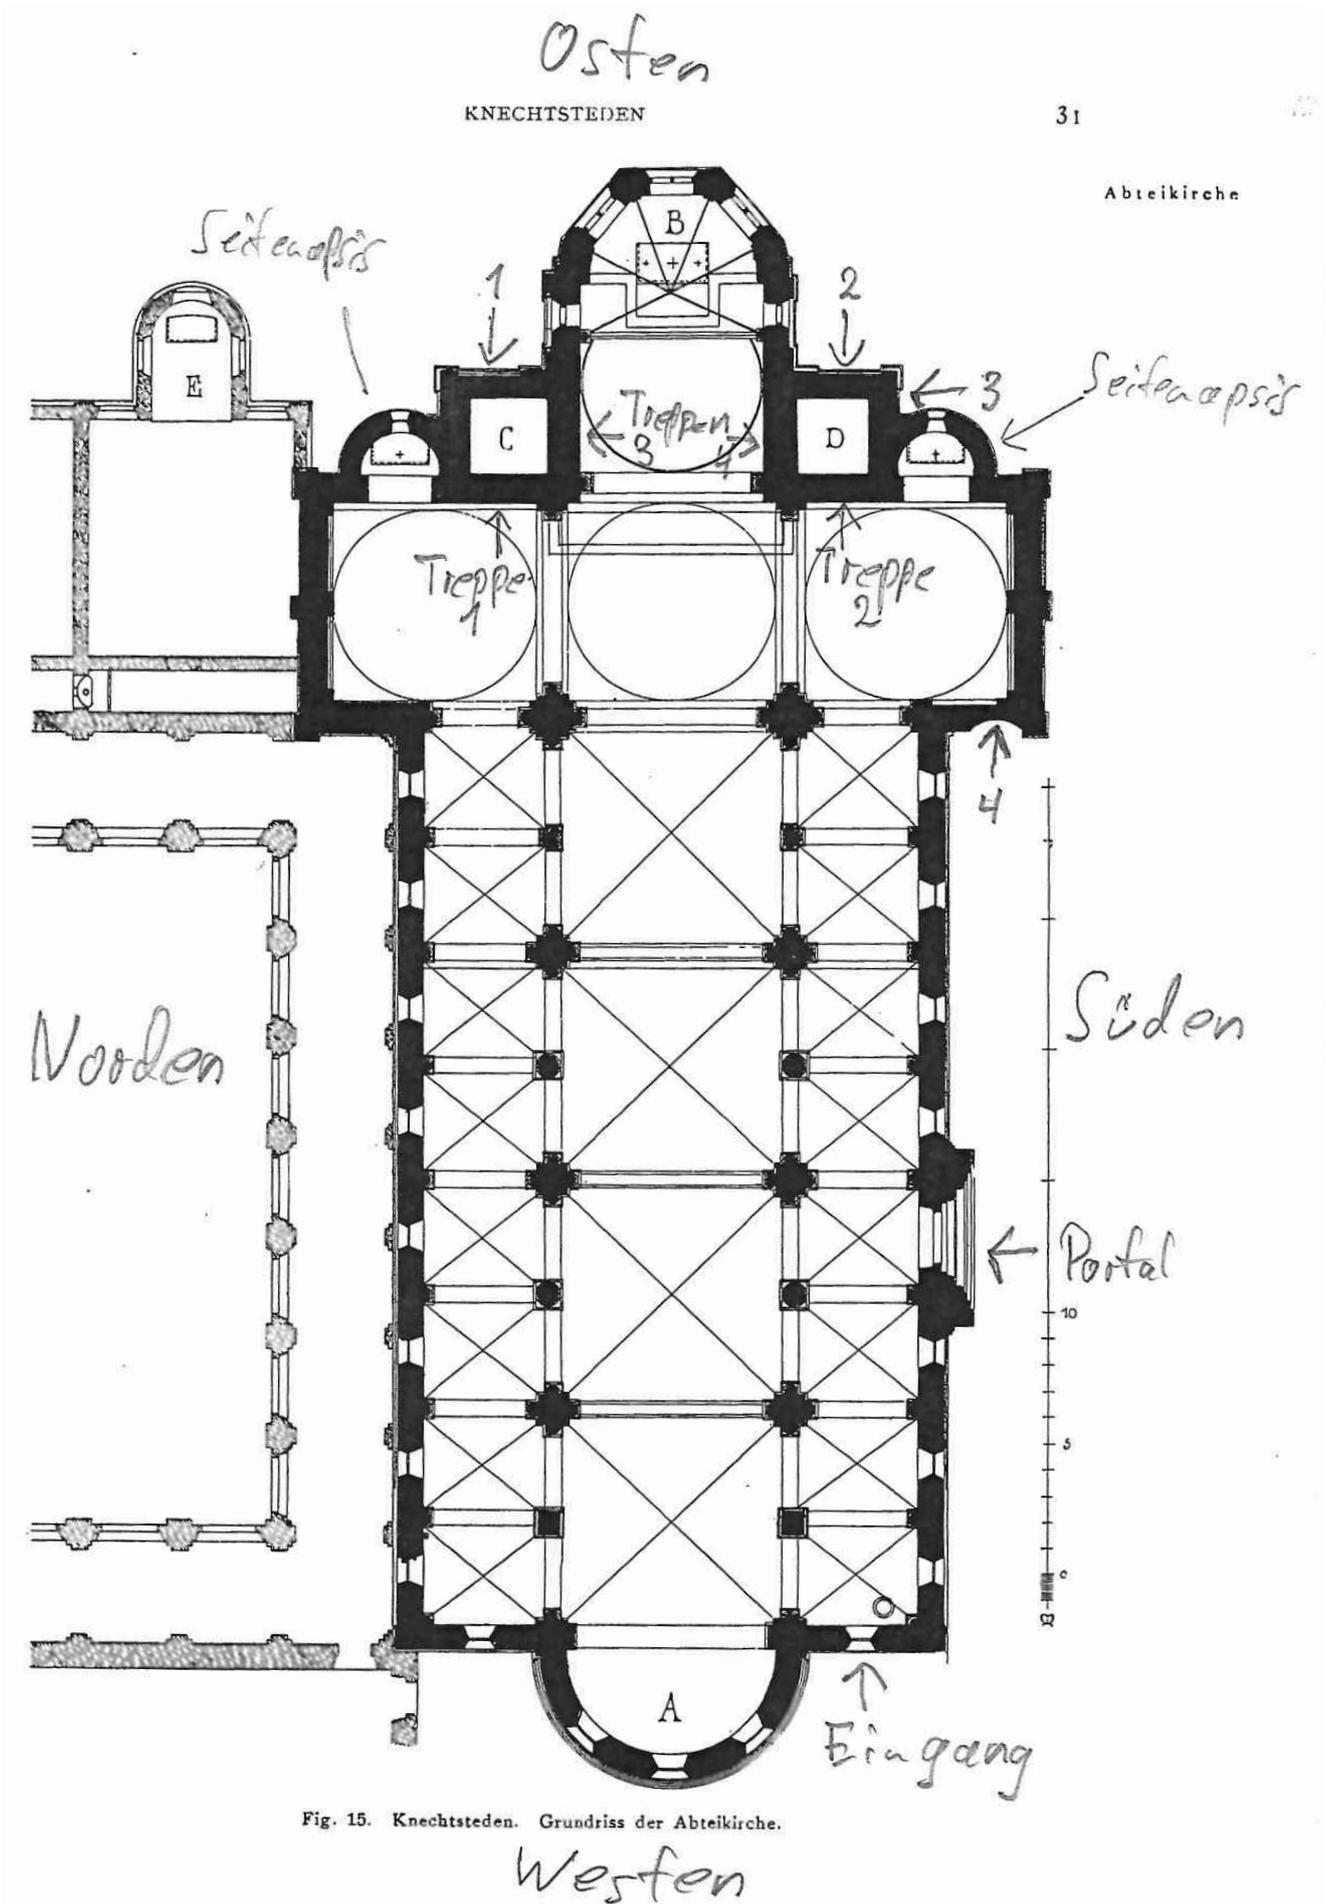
Knechtsteden. Grundriss der Abteikirche.
